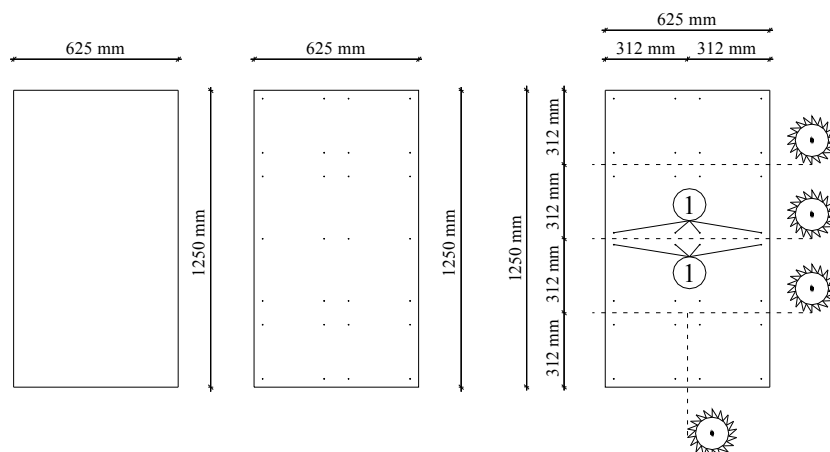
Desky s perem a drážkou CETRIS® PD
